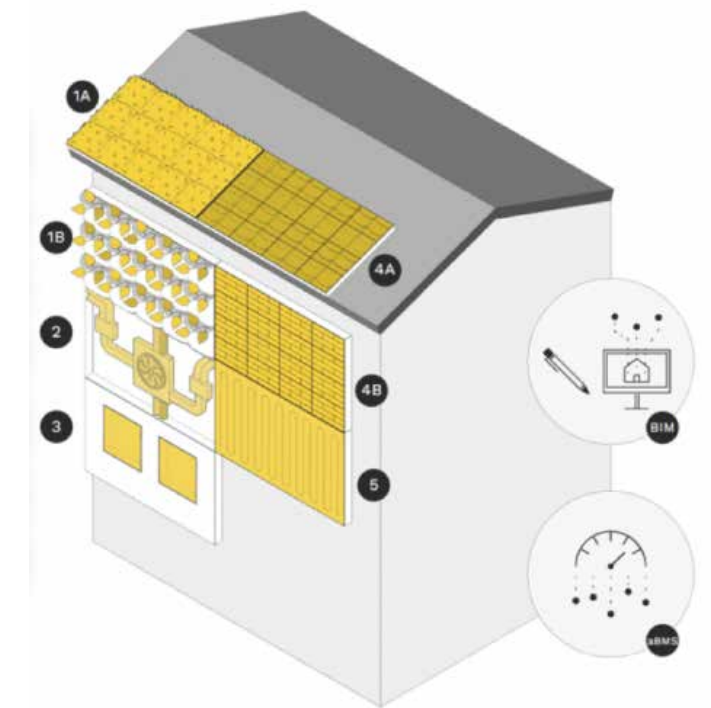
Rappresentazione grafica dei kit proposti dal progetto Infinite
